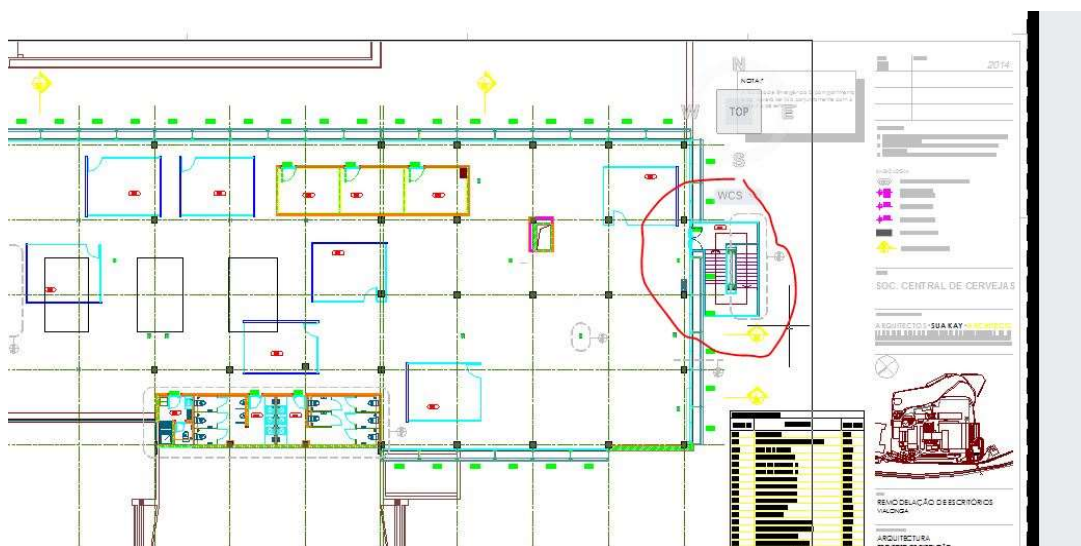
POSIÇÃO INICIAL DA ESCADA METÁLICA
